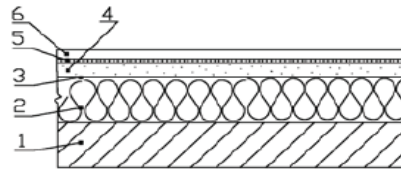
Конструктивний варіант улаштування теплоізоляції перекриття із суцільних плит на стороні житлових приміщень першого поверху:
